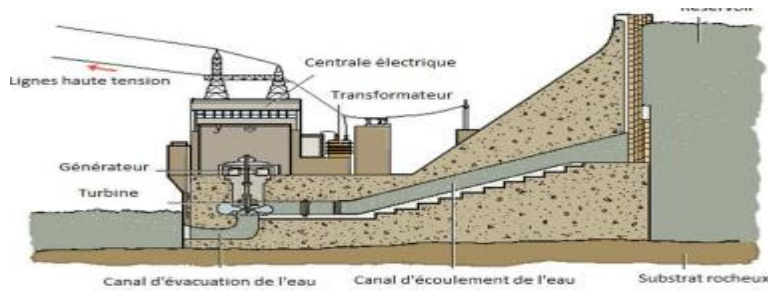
Exemple du principe d'une centrale hydraulique.
